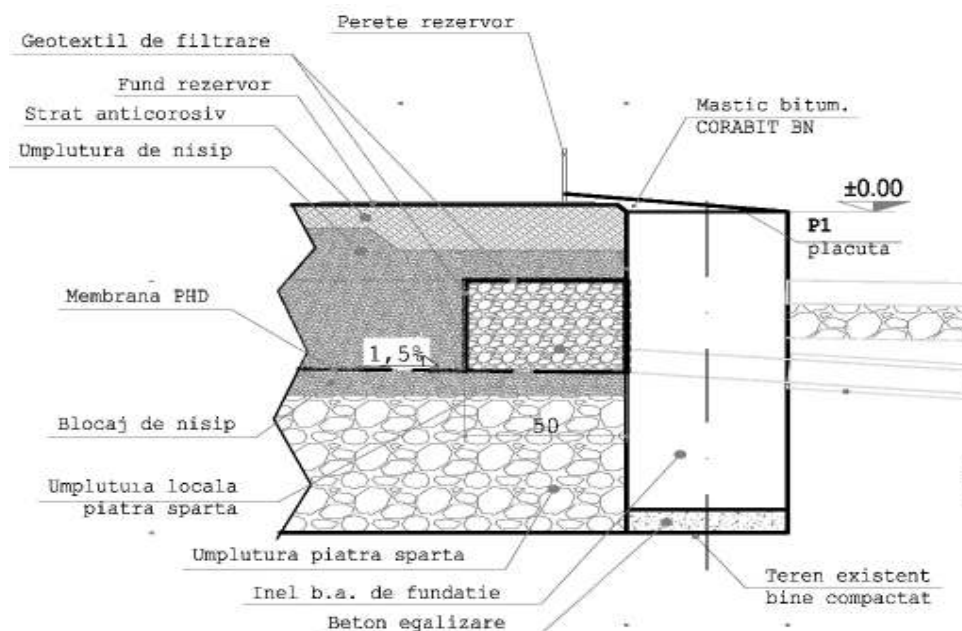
Fundații pe pat elastic cu inel de beton
